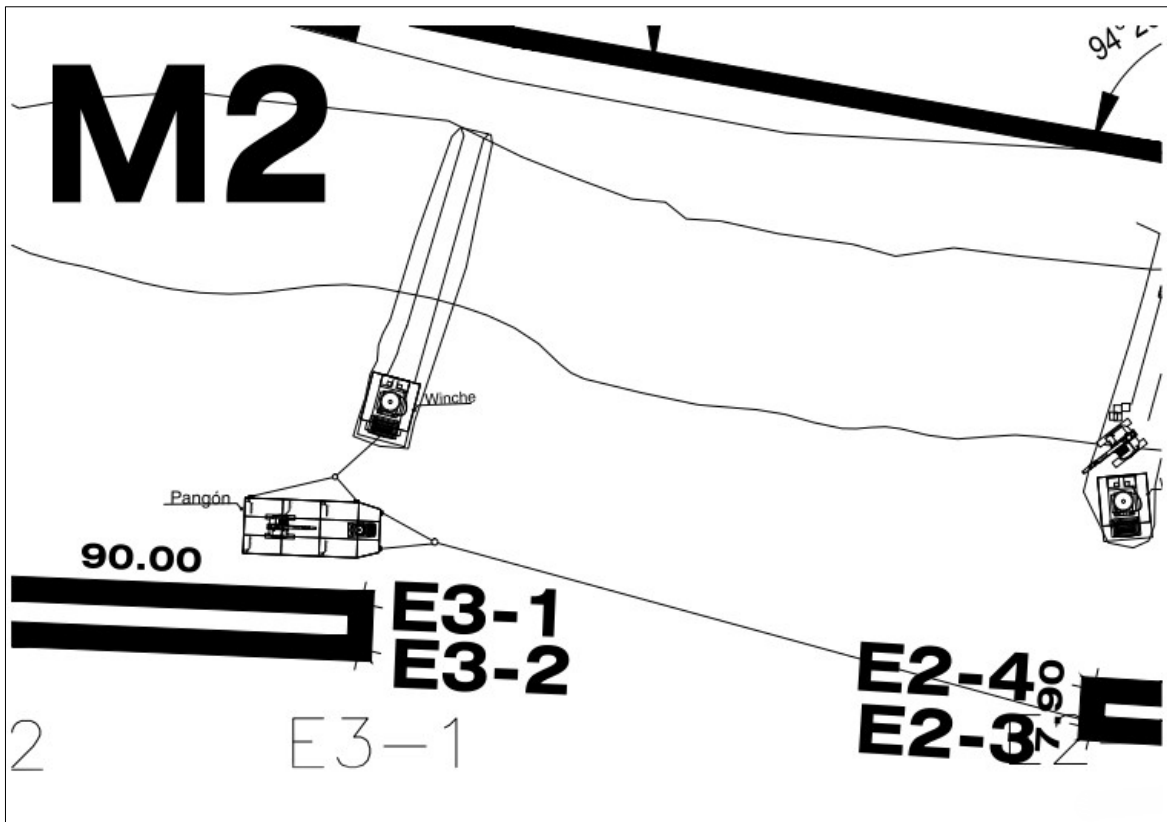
Sistema de remolque con el uso de winches para la construcción de la estructura 2 (Anexo II.6).
